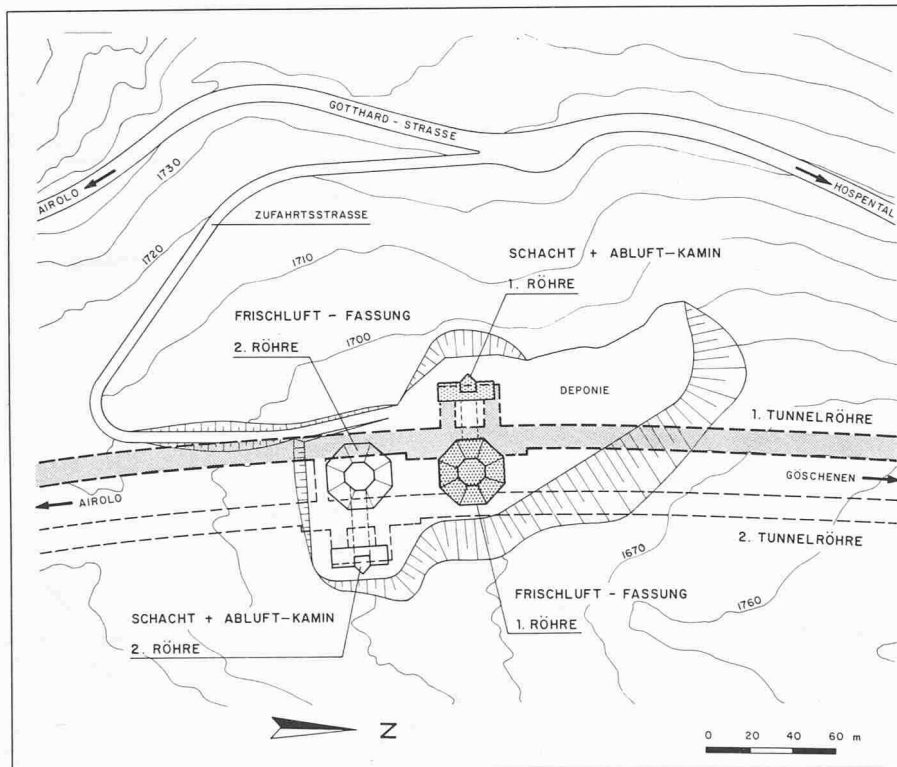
Zone Guspisbach. Disposition der Anlagen im Endausbau mit zwei Tunnelröhren
